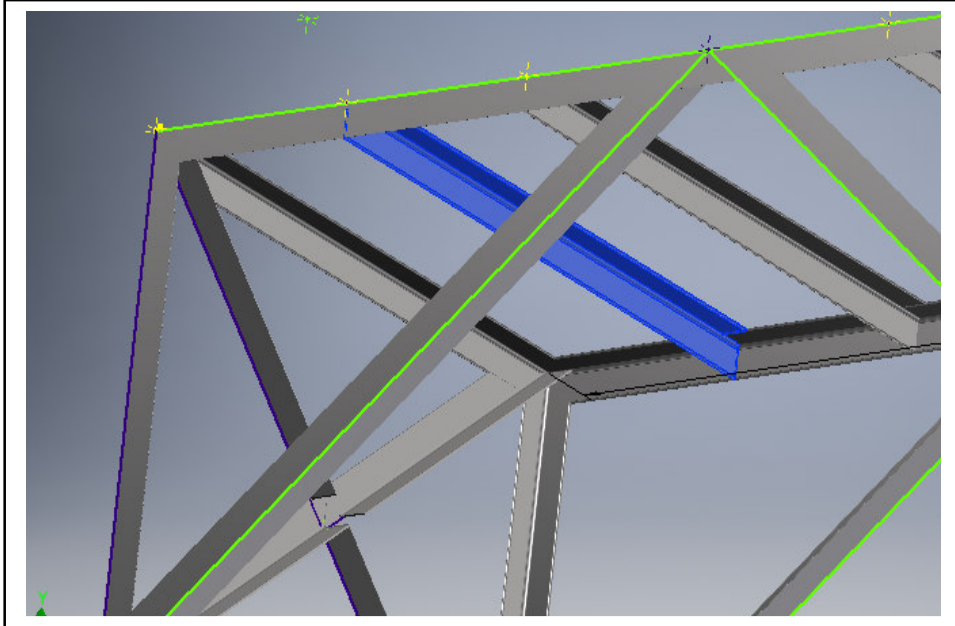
Factores geométricos para el análisis de soldaduras
